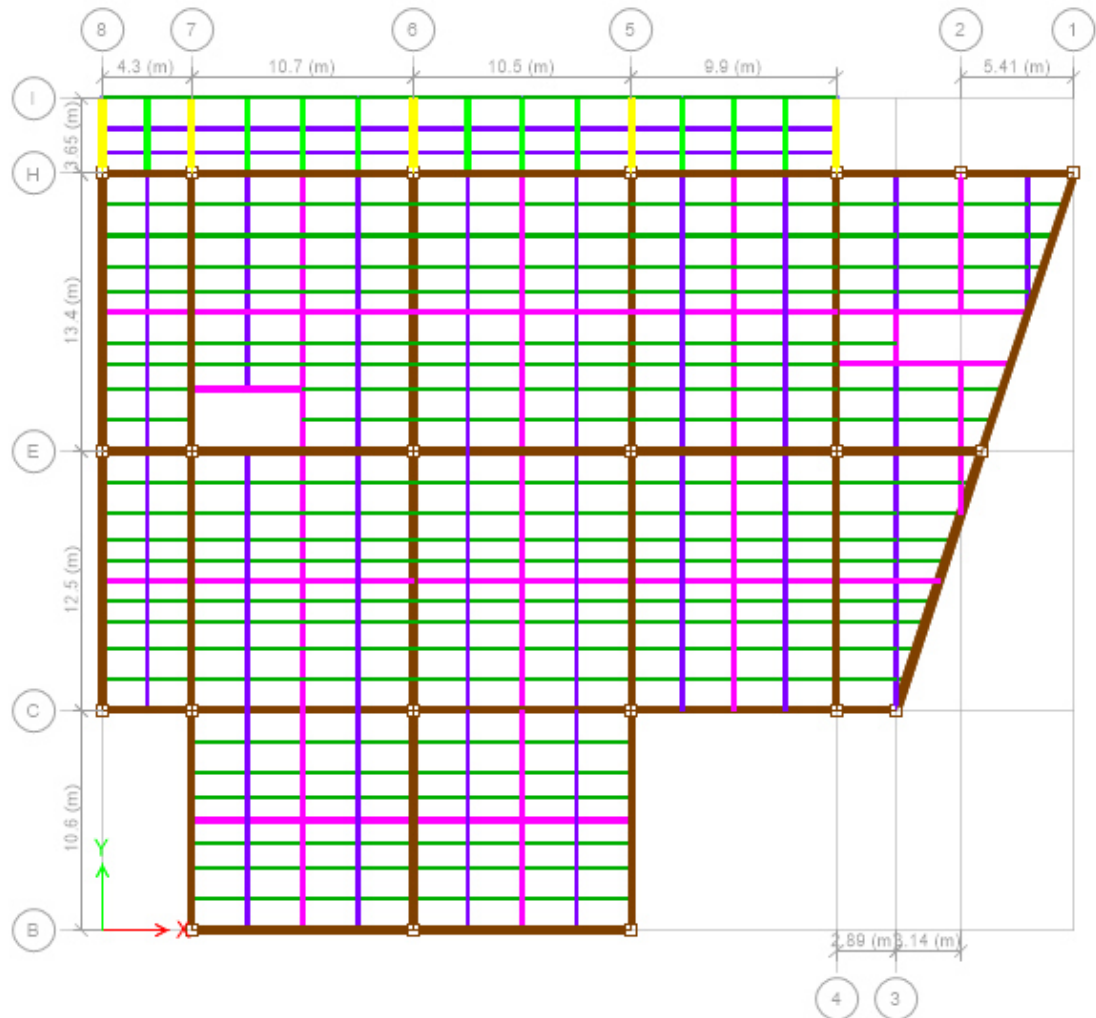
Distribución de vigas en planta del piso 2 (9.88 m).
